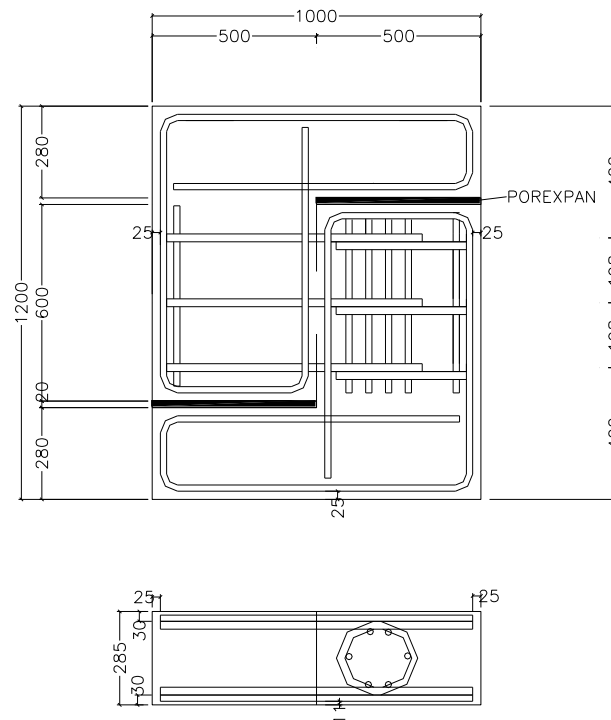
Croquis de las armaduras en los paneles con Loop Joints.
